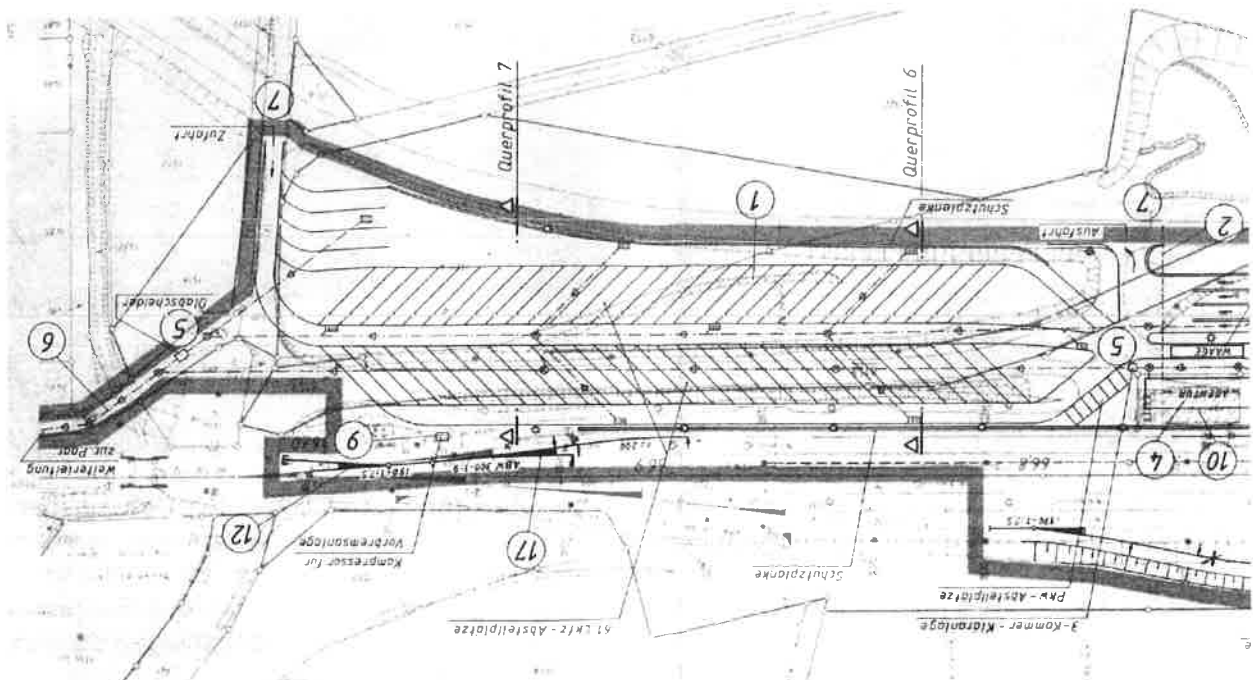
Planzeichnung des Planfeststellungsbeschlusses für das Plangebiet
